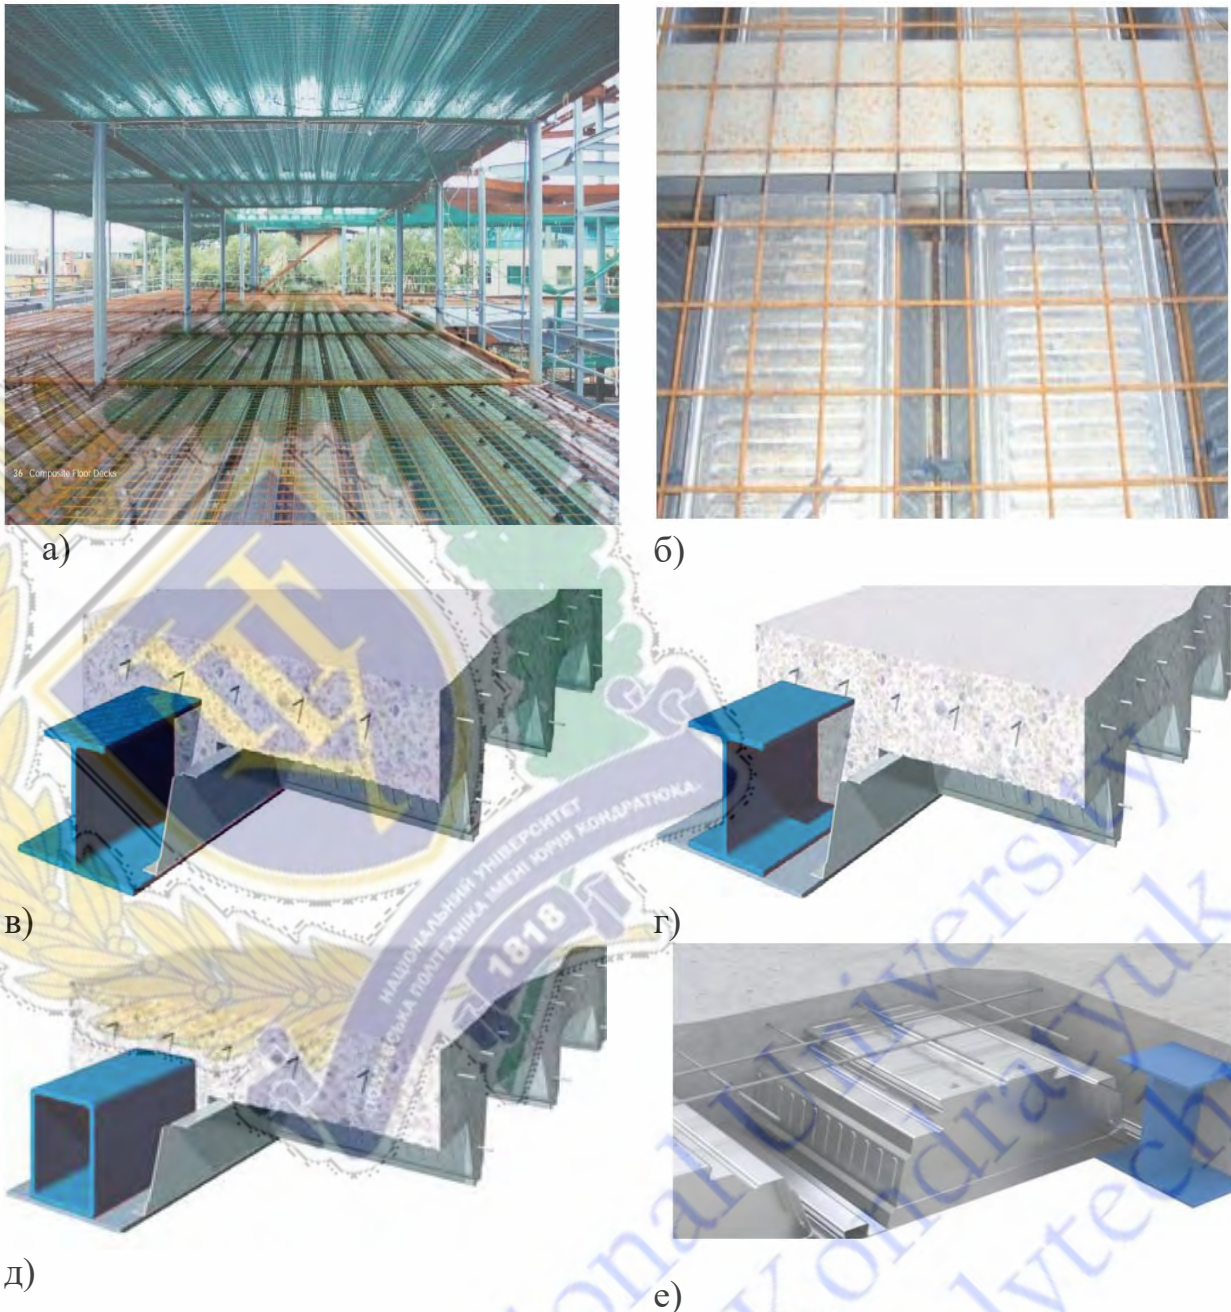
Сталезалізобетонне перекриття із комбінованих плит із нез'ємною опалубкою у вигляді профільних гнутих сталевих листів та другорядних балок із конструкційних складених профілів різних перерізів, які улаштовані в рівень висоти перерізу комбінованої плити: а – загальний вигляд перекриття; б) армування перекриття; фрагменти перекриття із несучою другорядною балкою: в) прокатного перерізу; г) складеного перерізу із двотавра і полоси; д) складеного перерізу із прямокутної труби і полоси; е) прокатного двотаврового перерізу та профільного гнутого листа, який підсилений знизу додатковим плоским оцинкованим листом у улаштуванням утеплювача в нішах трапецієвидних гофрів профільного листа.
